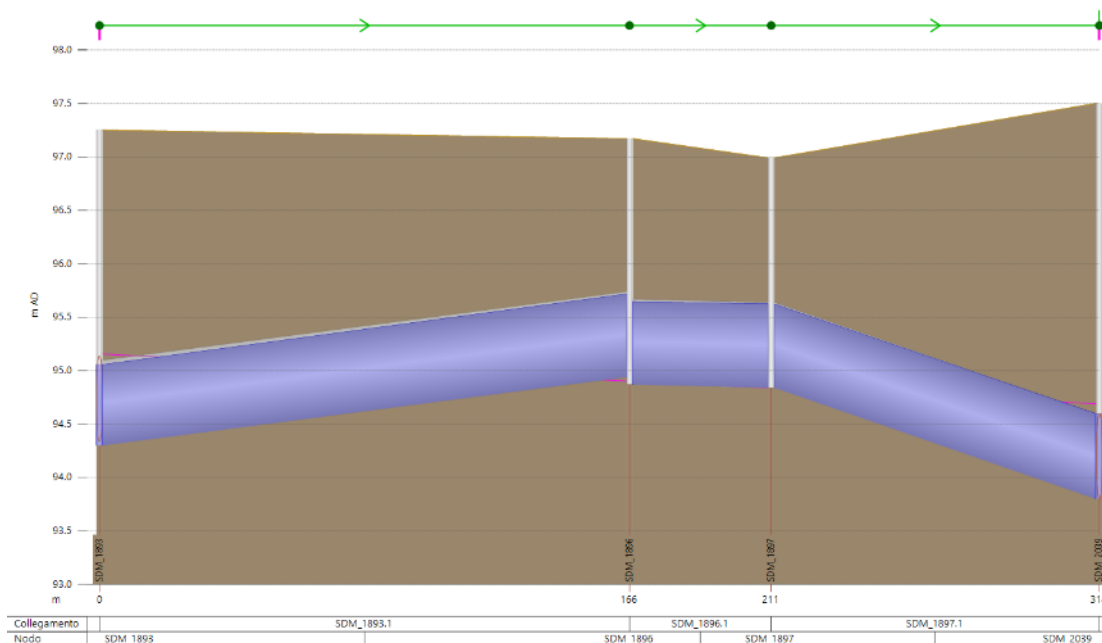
Profilo stato di fatto tratto di dorsale centrale in zona ospedale
